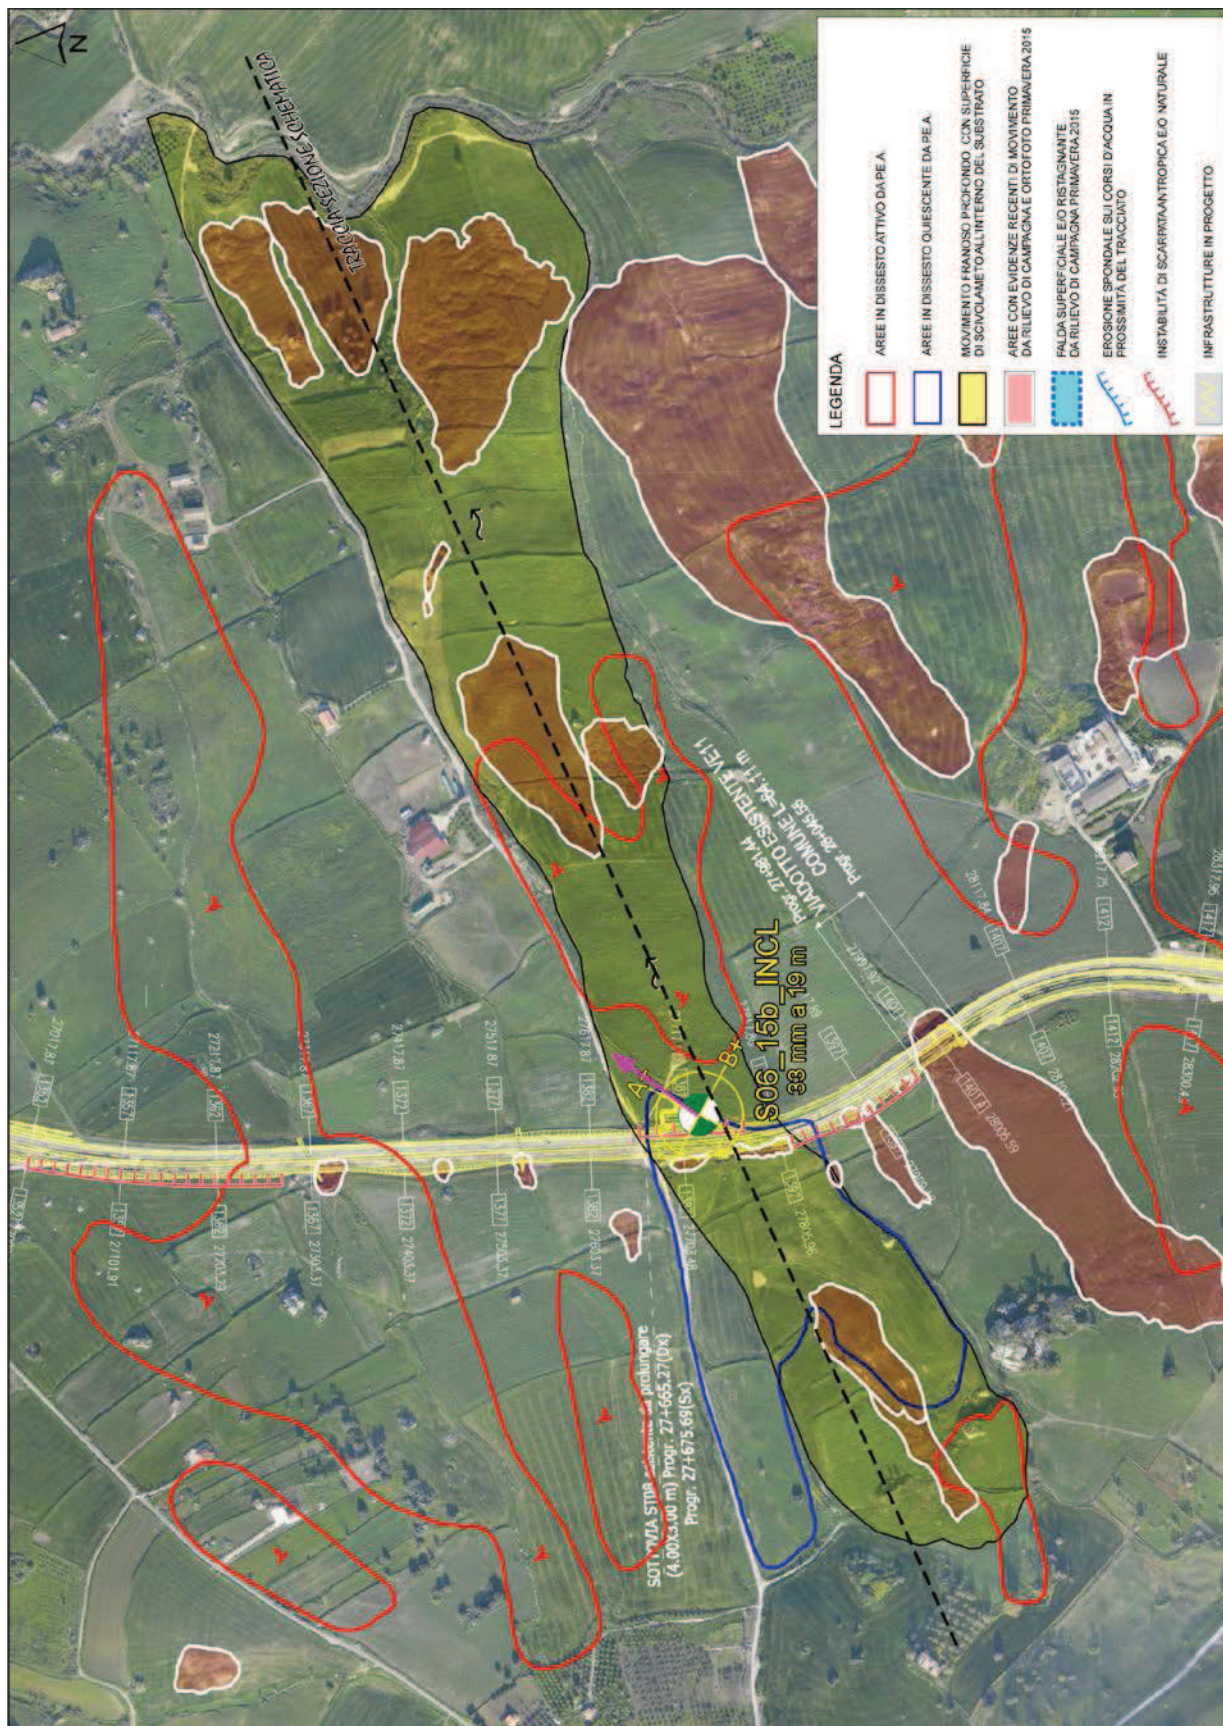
PK 27+730. Individuazione planimetria dell'area in movimento
